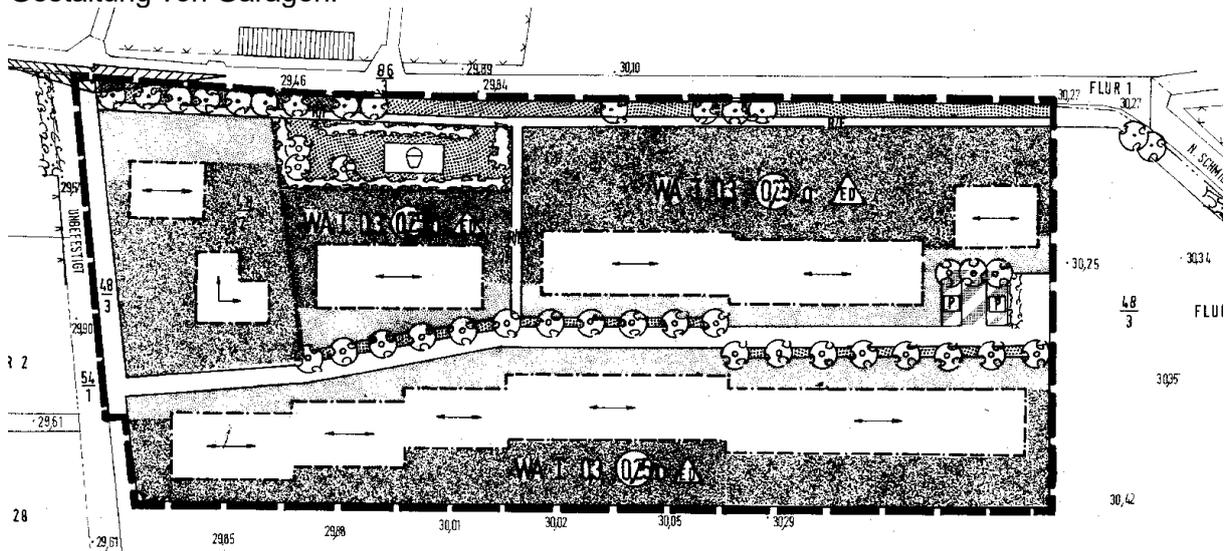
Planzeichnung (Teil A) des B-Plans Nr. 1 der damaligen Gemeinde Kandelin „Eigenheimstandort Kandelin“, rechtskräftig seit 14.03.1994
